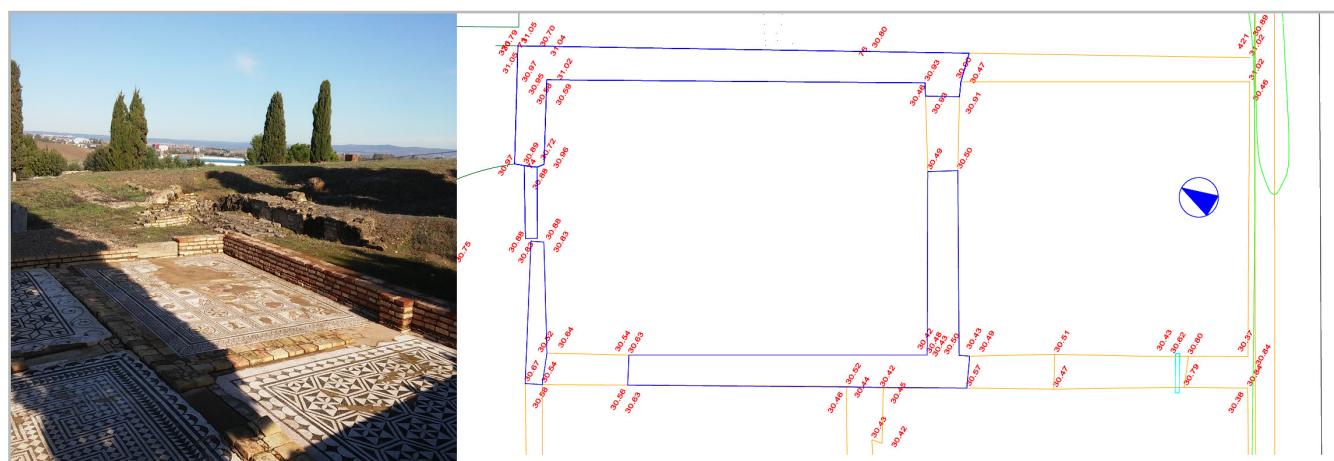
Fotografía de emplazamiento y levantamiento planimétrico.
